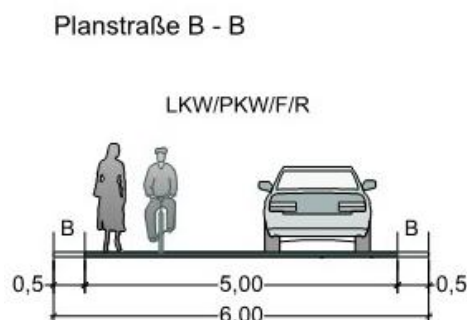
Straßenquerschnitt der Planstraße B, ohne Maßstab
